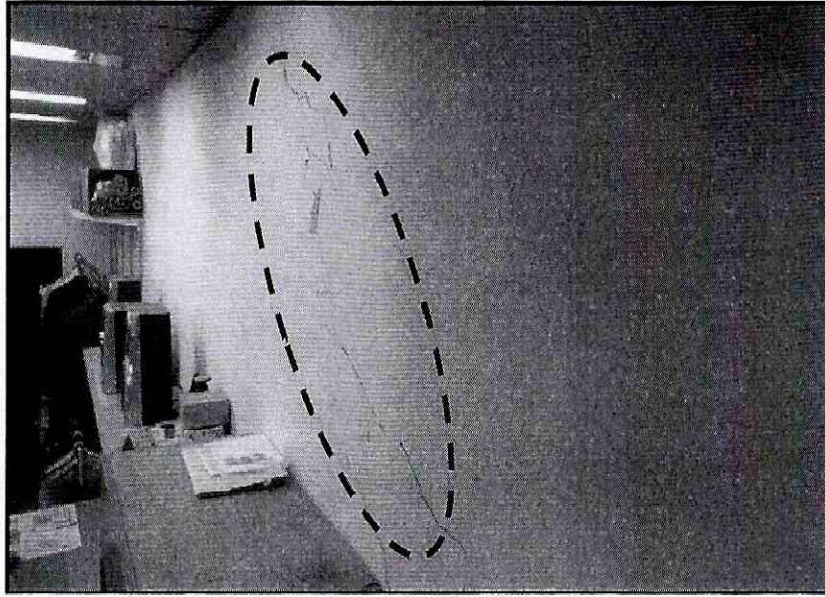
Fisuras en muro en el interior del primer piso
